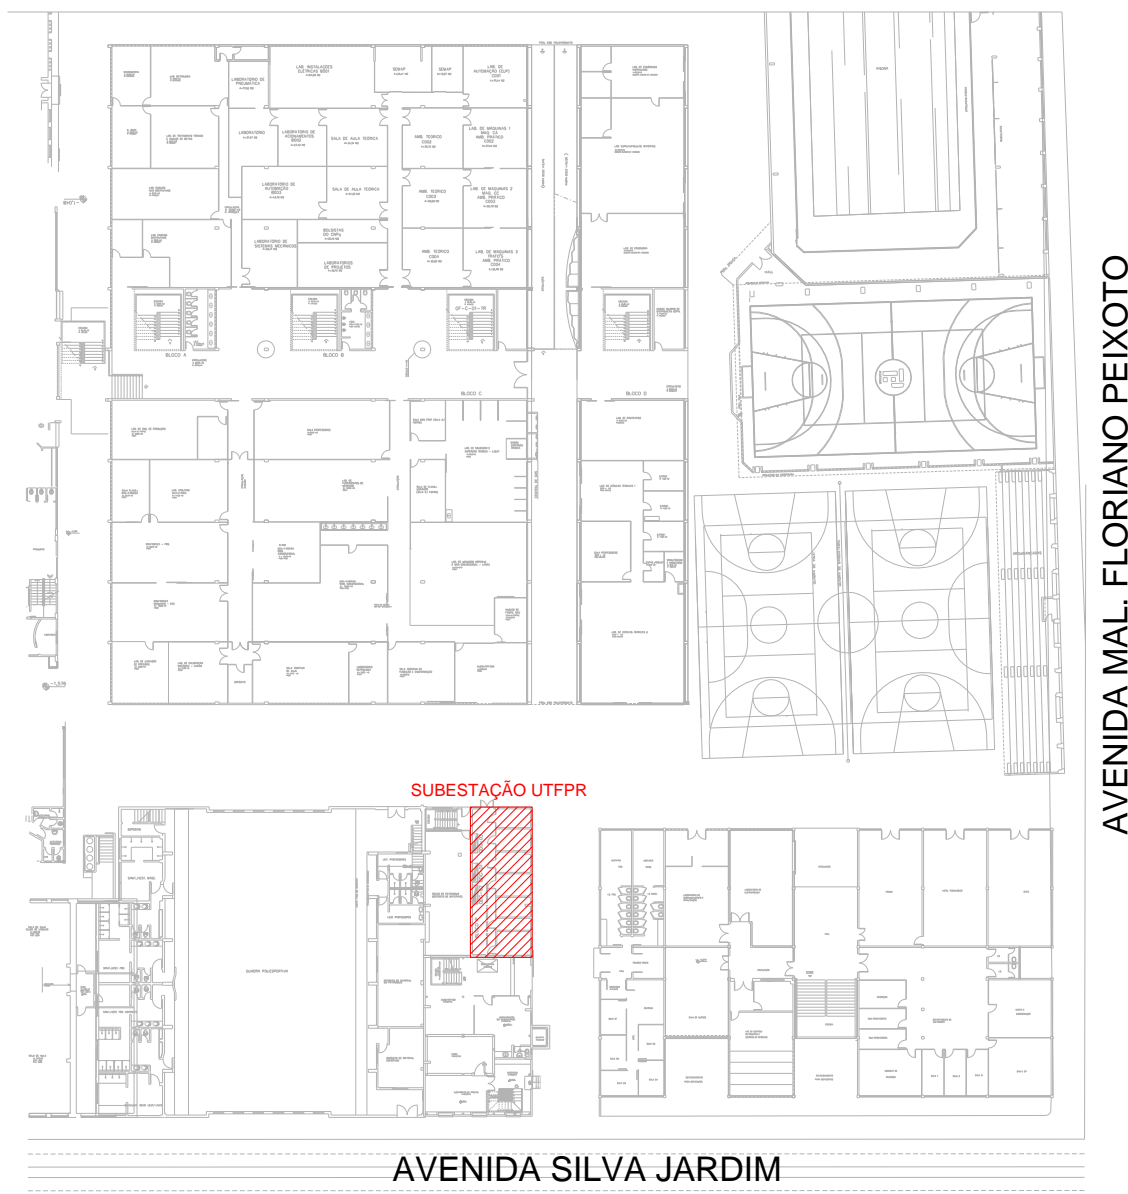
Planta Baixa da Subestação MT da UTFPR
